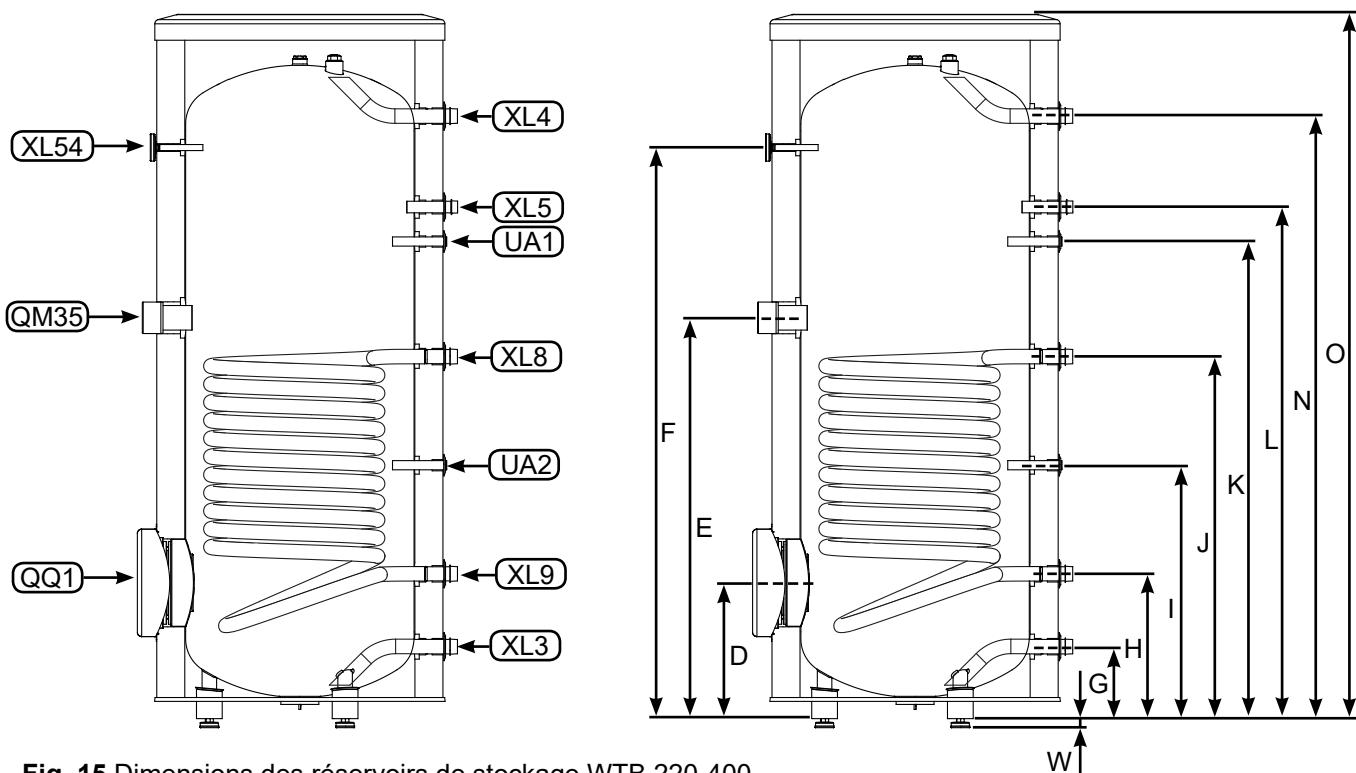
Dimensions des réservoirs de stockage WTB 220-400
